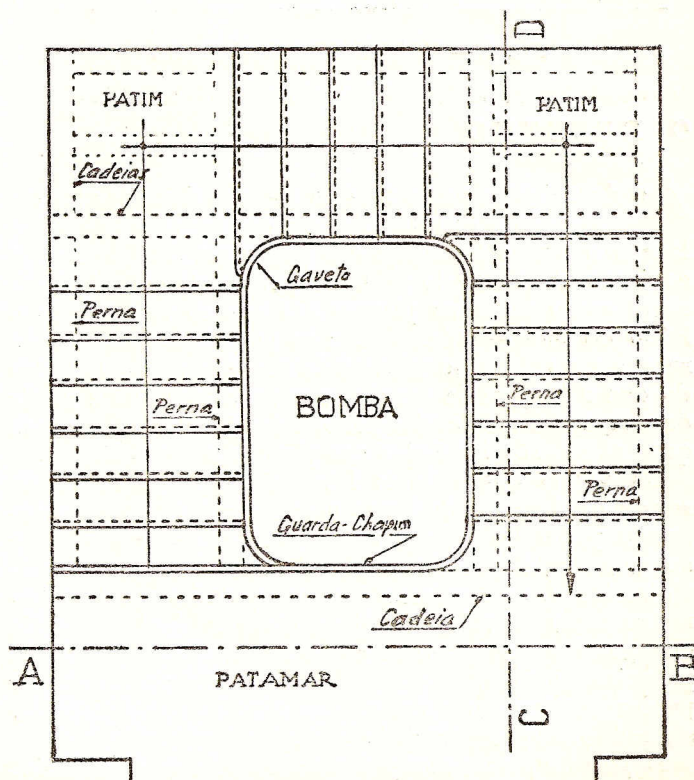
PLANTA DA ESCADA NO SEU FINAL
